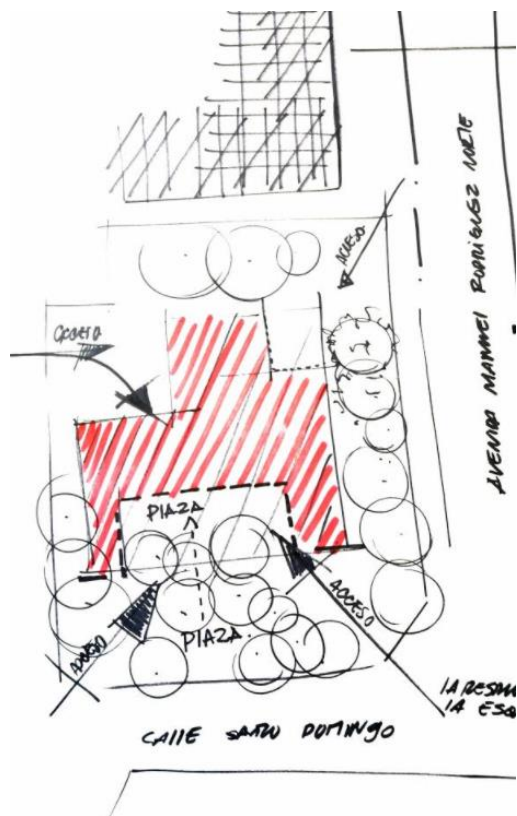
Croquis iniciales del proyecto, idea en planta de una plaza central como elemento integrador entre la ciudad y la edificación.
